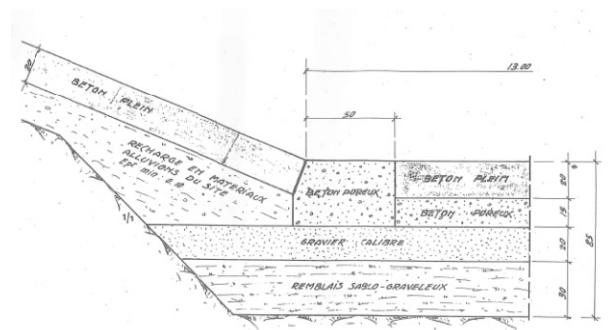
COUPE DE DÉTAIL DU PIED DE DIGUE (LONGRINE, COUCHES DE FONDATION ET DALLE EN BÉTON)
